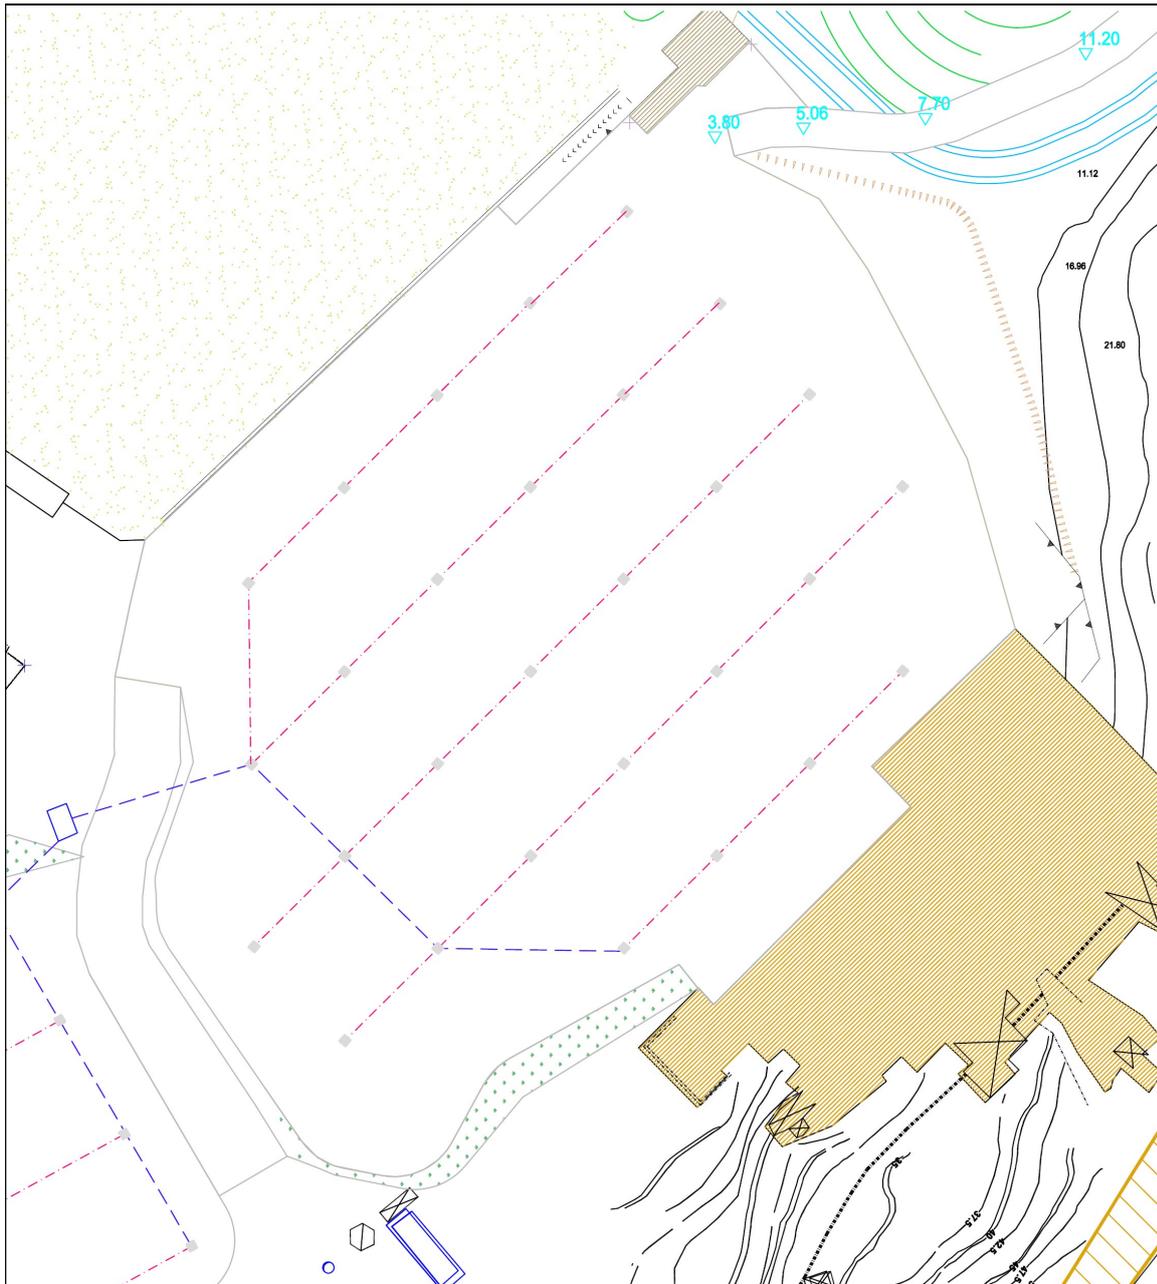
Planimetria dell'area campo sportivo con la rappresentazione delle opere in progetto
